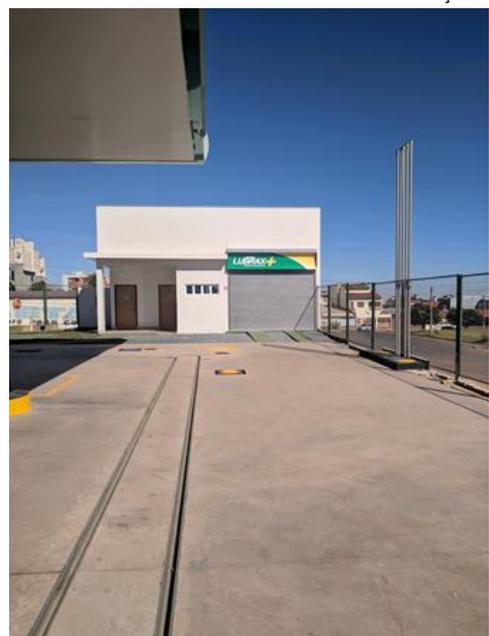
Pista de abastecimento com canaletas dentro da projeção da cobertura.
